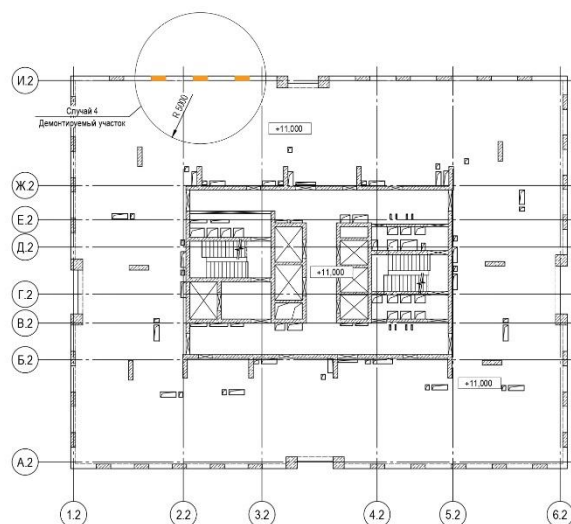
Корпус К-2. Схема аварийного случая 4
